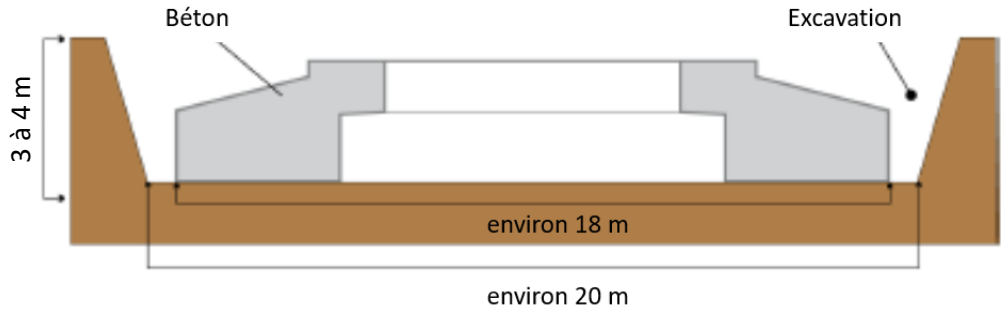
Schéma d'une fondation d'éolienne (source : Biotope)
